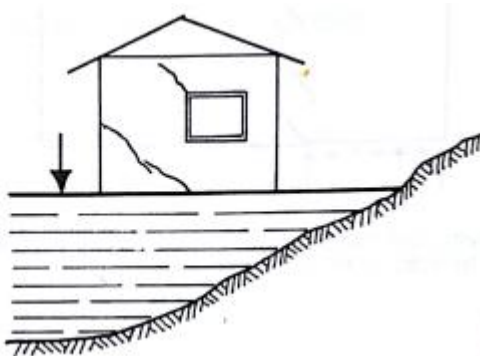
Fissuras causadas por consolidação de aterro
